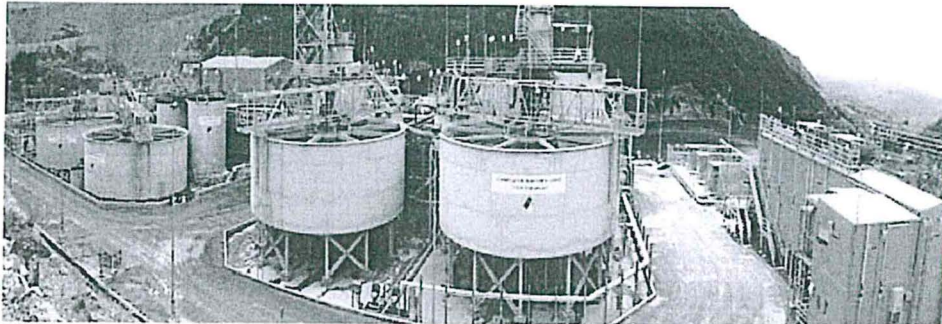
Vista general de la Planta de tratamiento Pucauran
